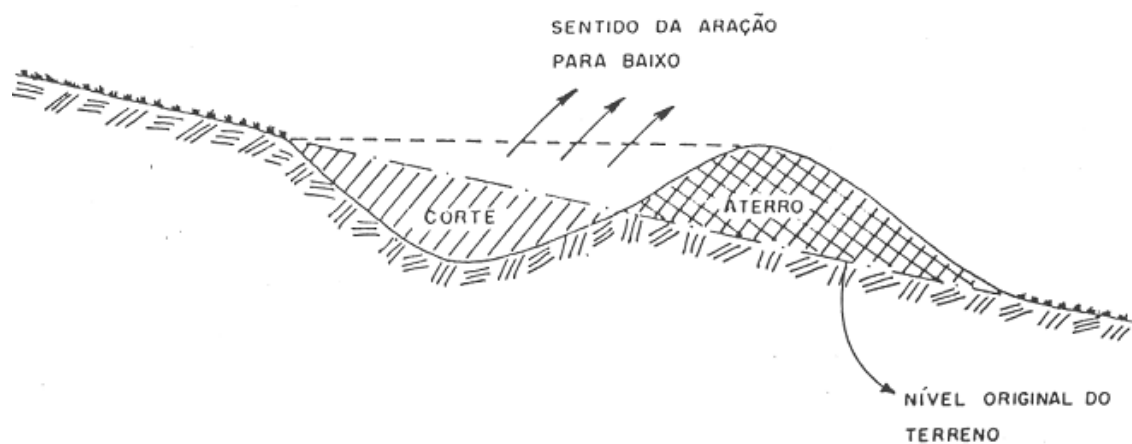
Esquema de perfil de terraço tipo Nichols, construído com arado tombando somente de cima para baixo.
